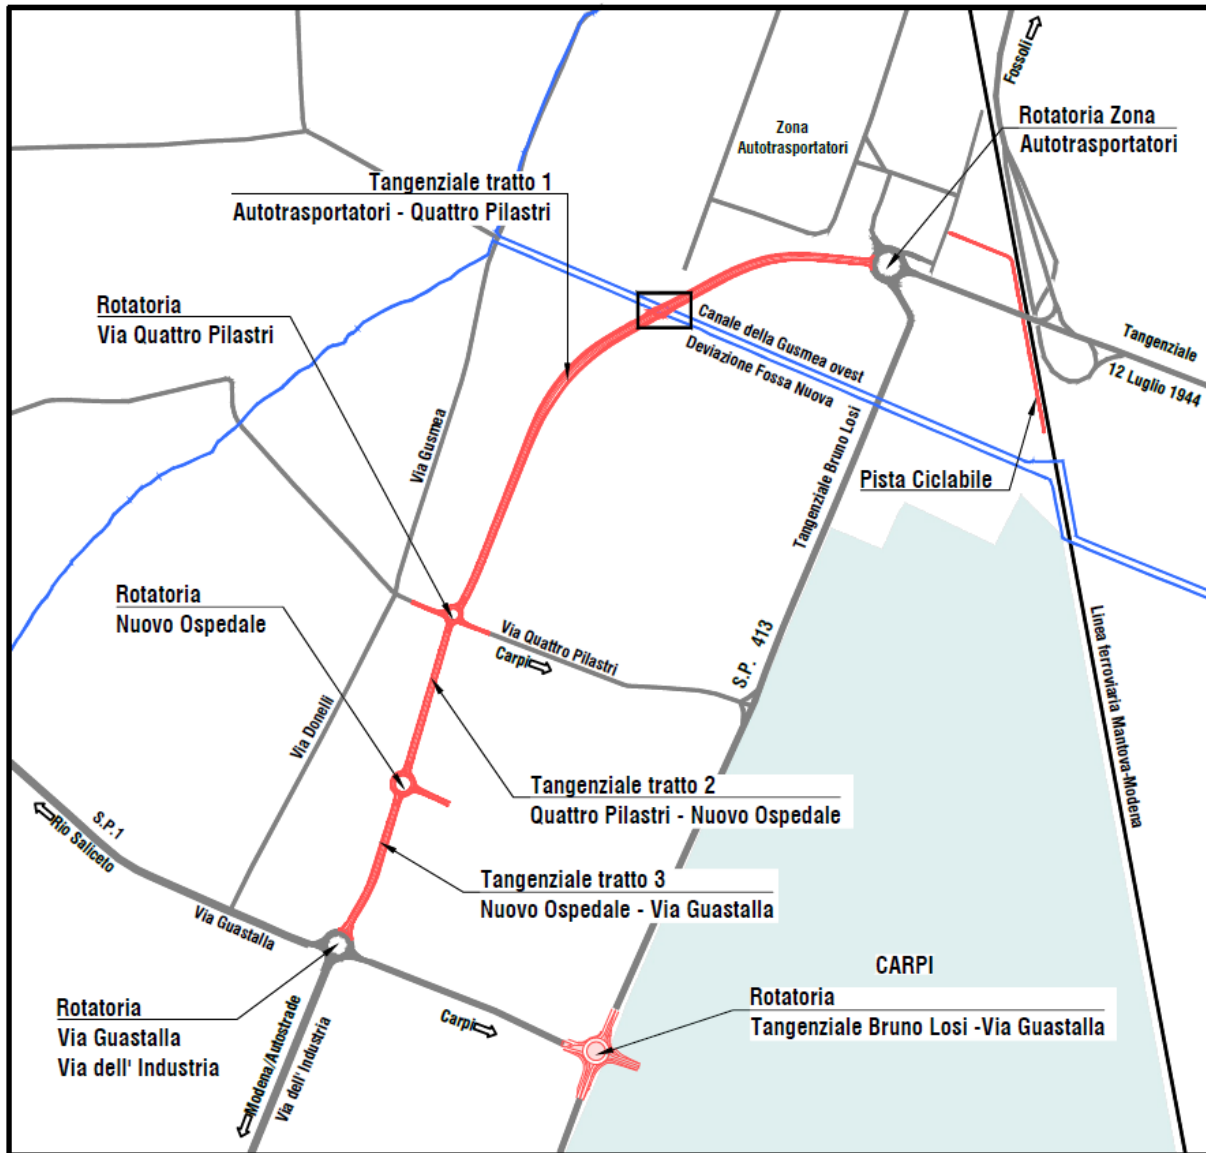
Planimetria generale: inquadramento delle opere maggiori.
